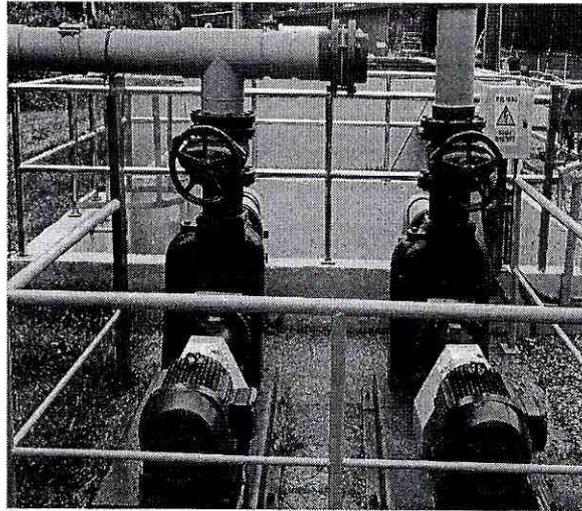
Vista Planta elevadora N°2 (UTM 18S 688.705 E; 5.585.657 S)
